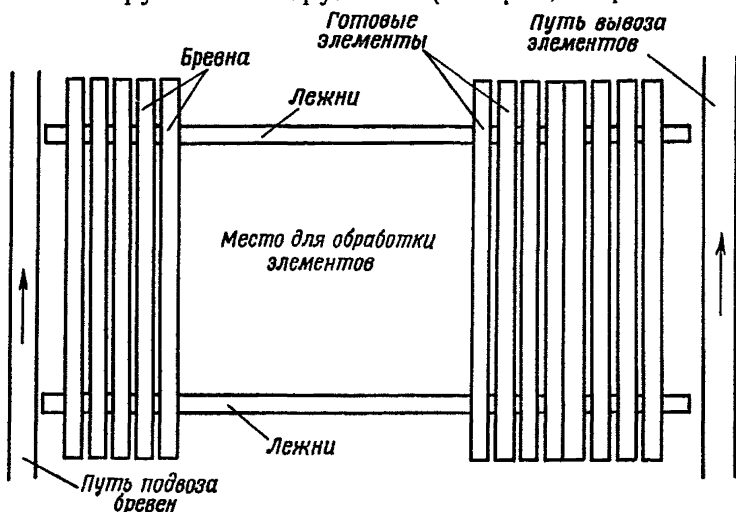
Схема рабочей площадки для изготовления элементов моста
